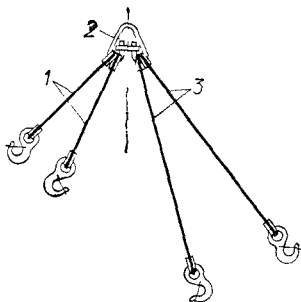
Специальный четырехветвевой строп для монтажа лестничных маршей
